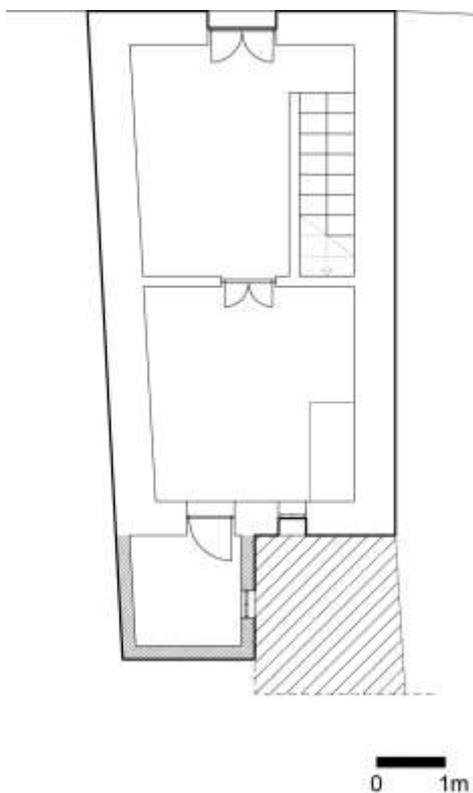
Planta de um piso 0 com adição de I.S.
